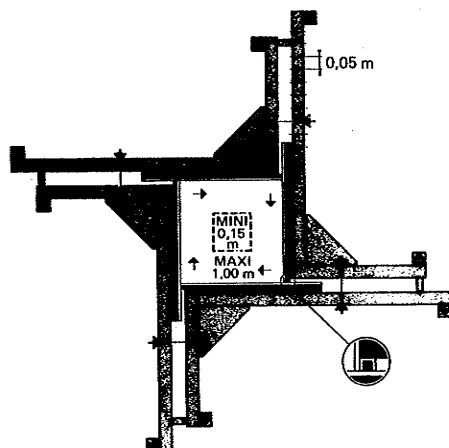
Principe de coffrage et de réglage du poteau en « AILES DE MOULIN ».
